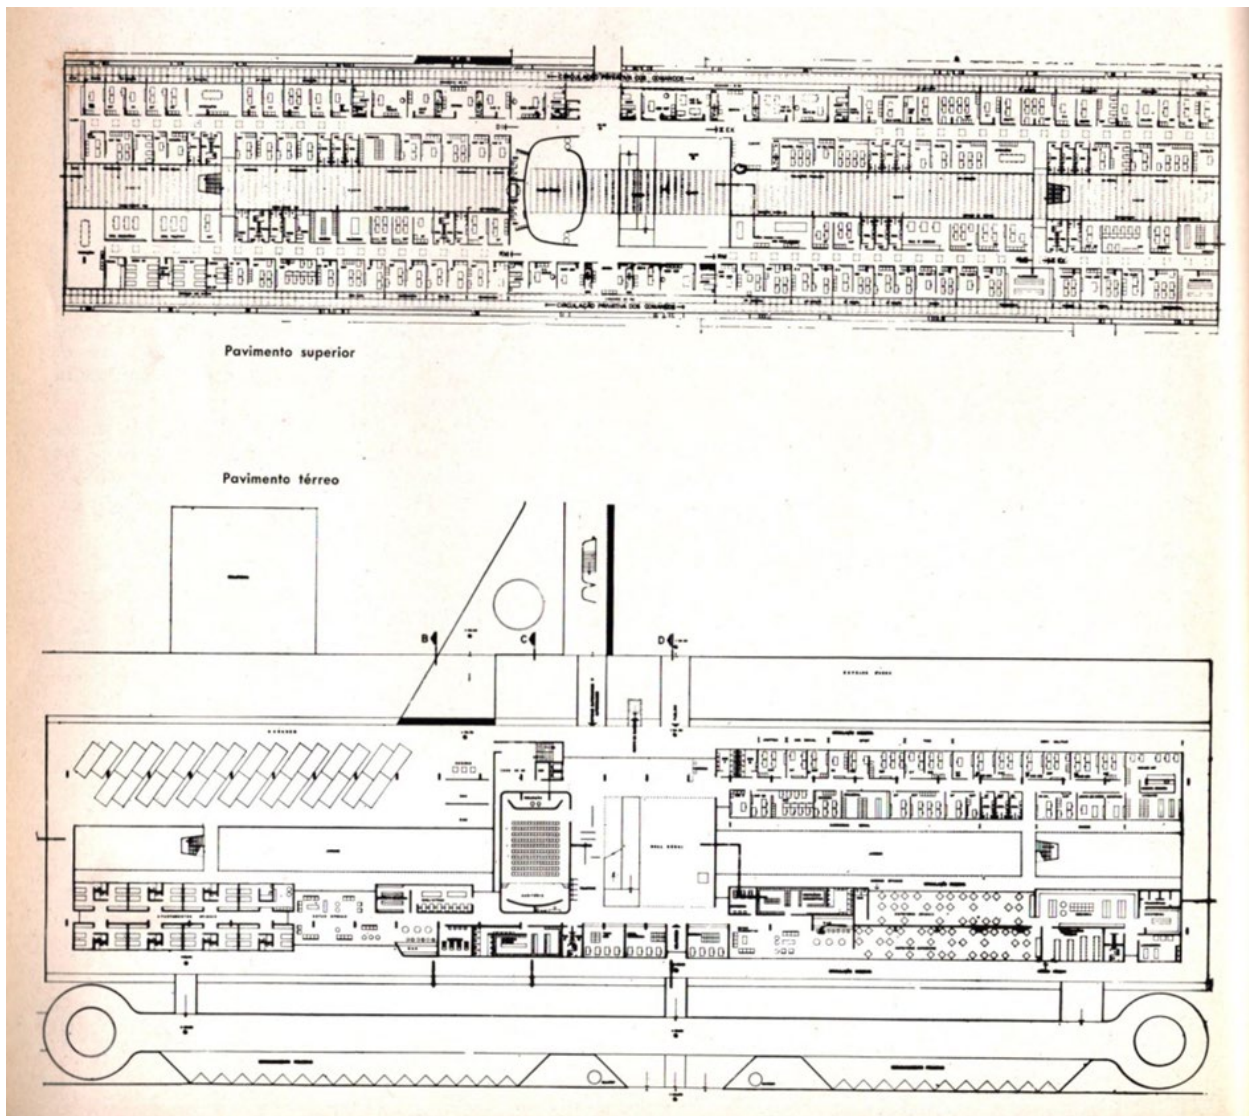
HQ main building floor plans: upper floor and lower level. Source: Revista Acrópolis 321, 1965
